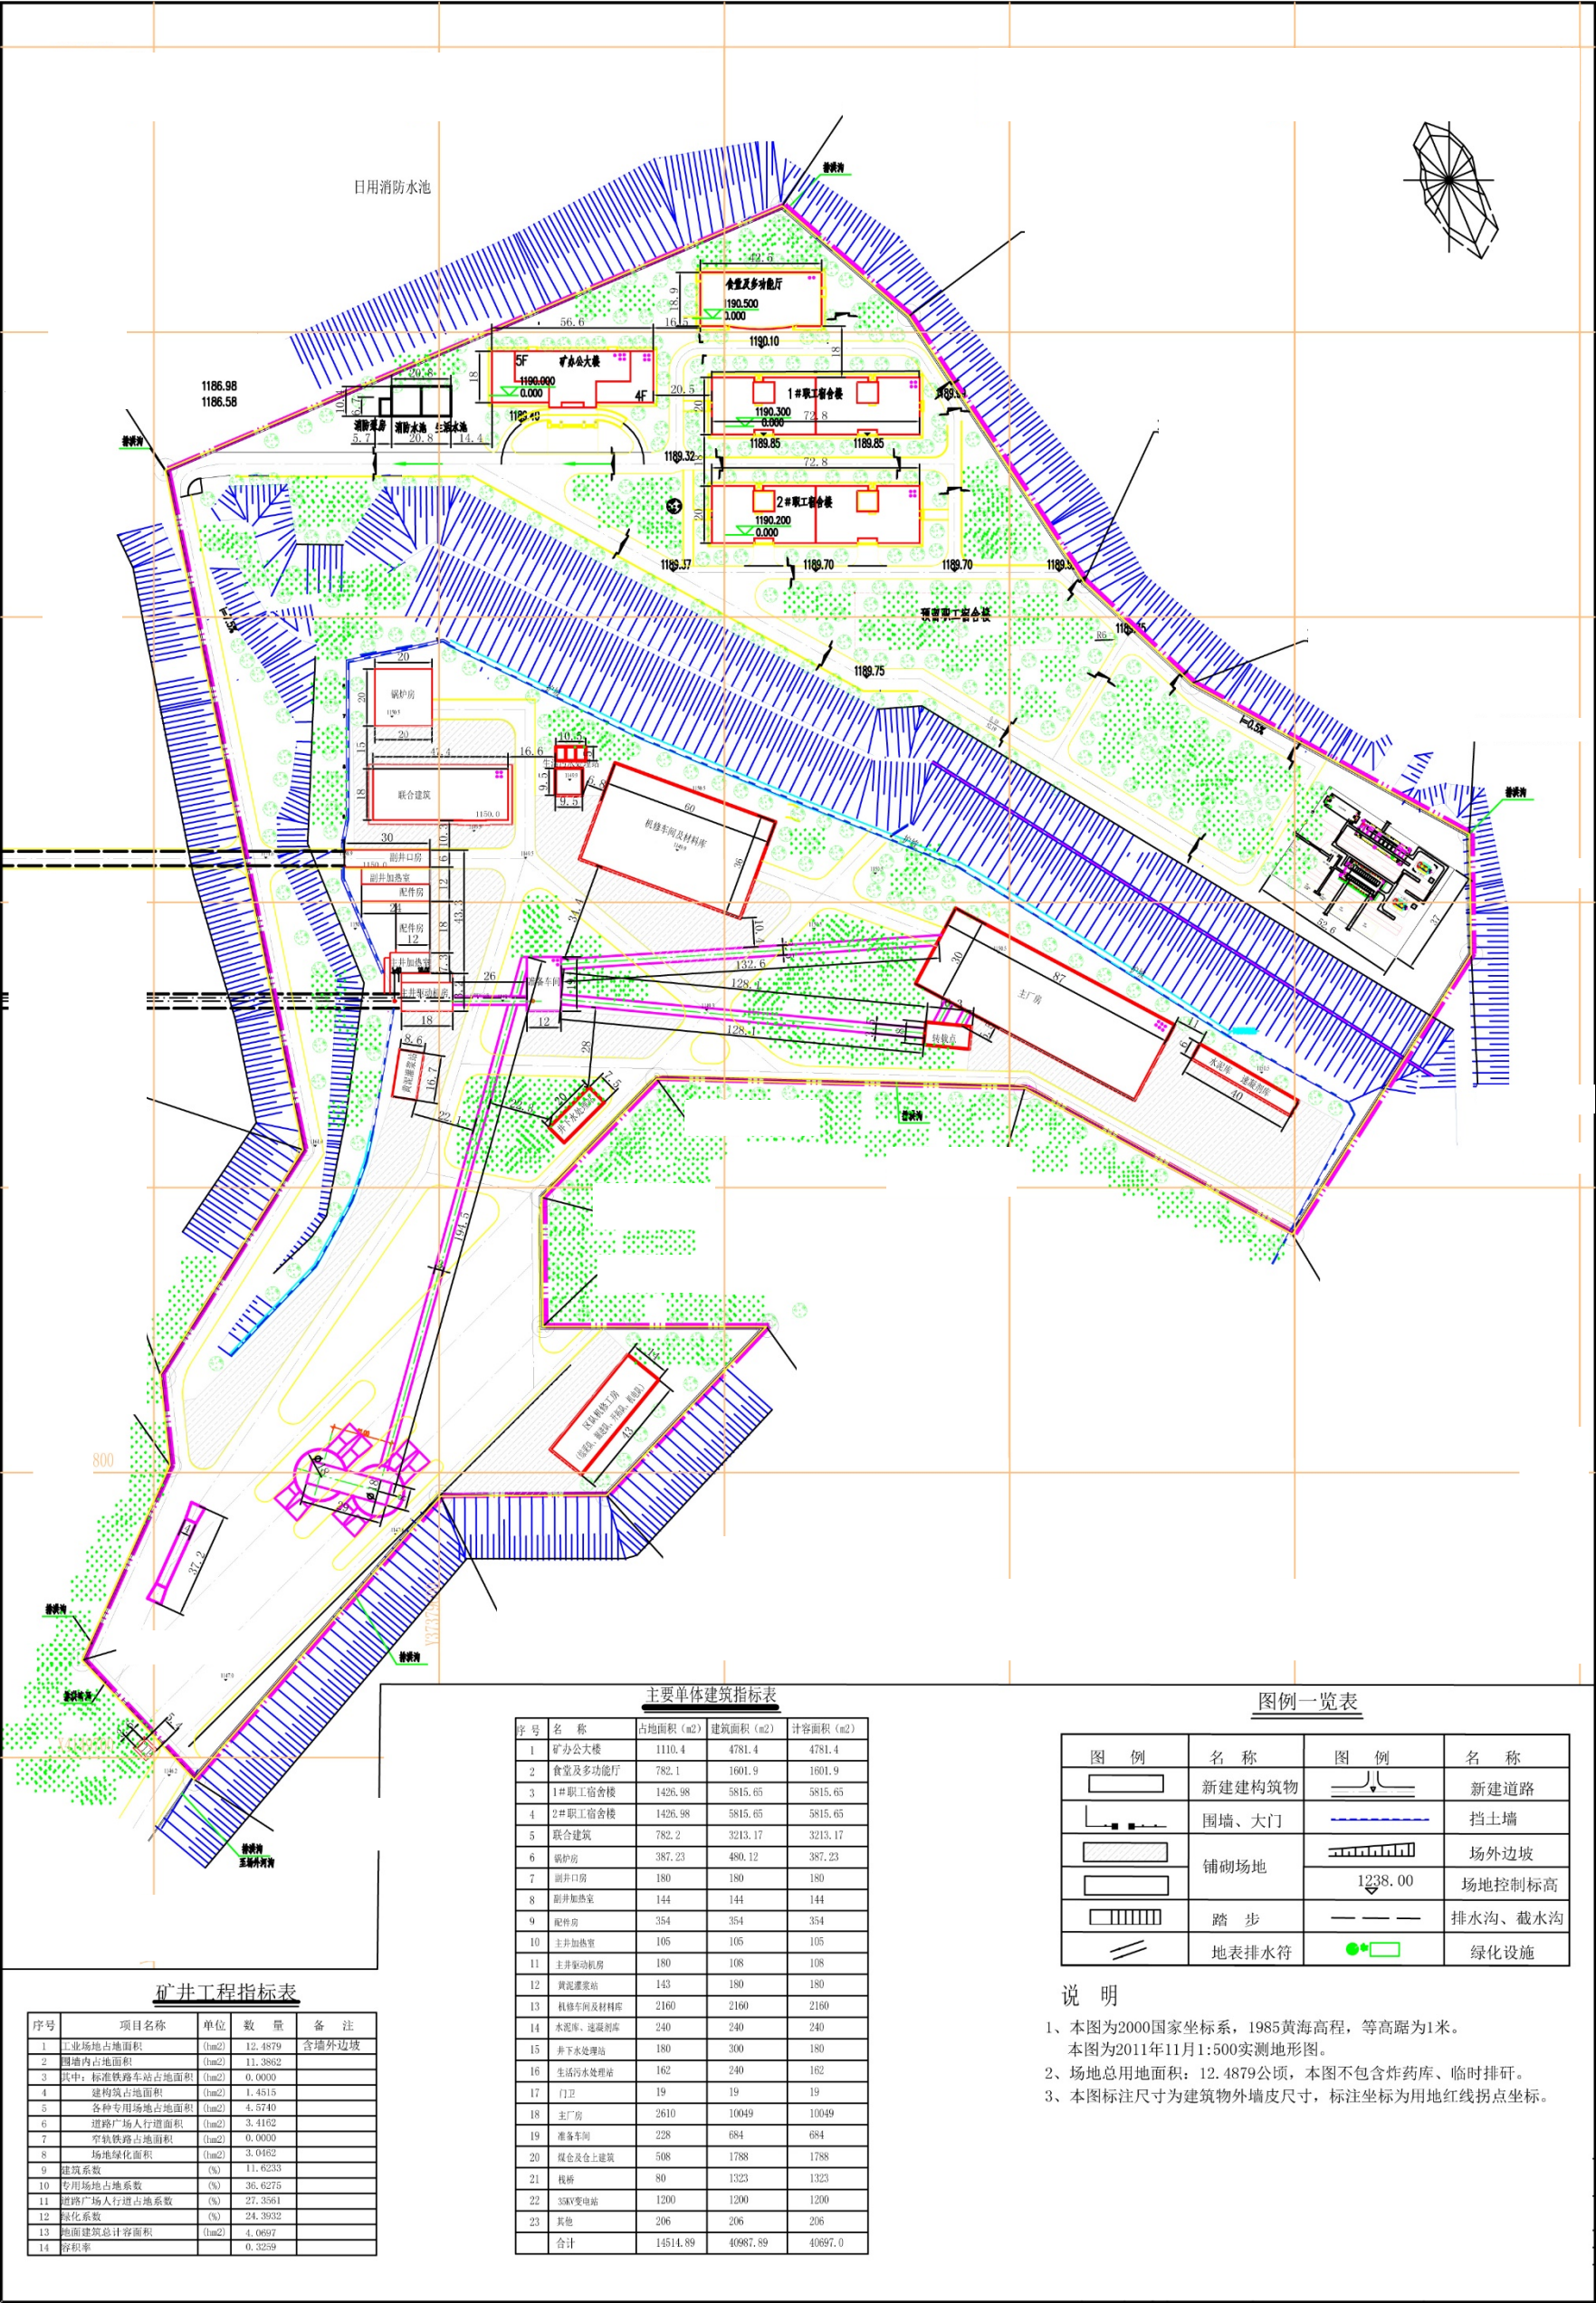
工业场地总平面布置图（来源于开发利用方案）
